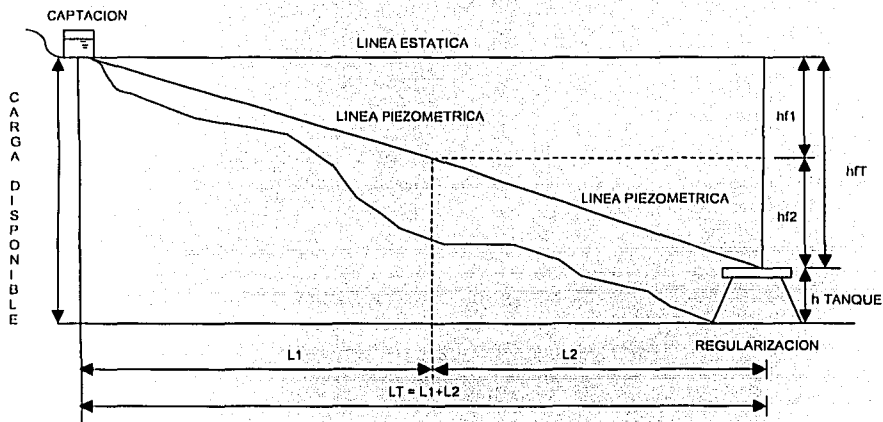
CASO No. 1 TERRENO PLANO
